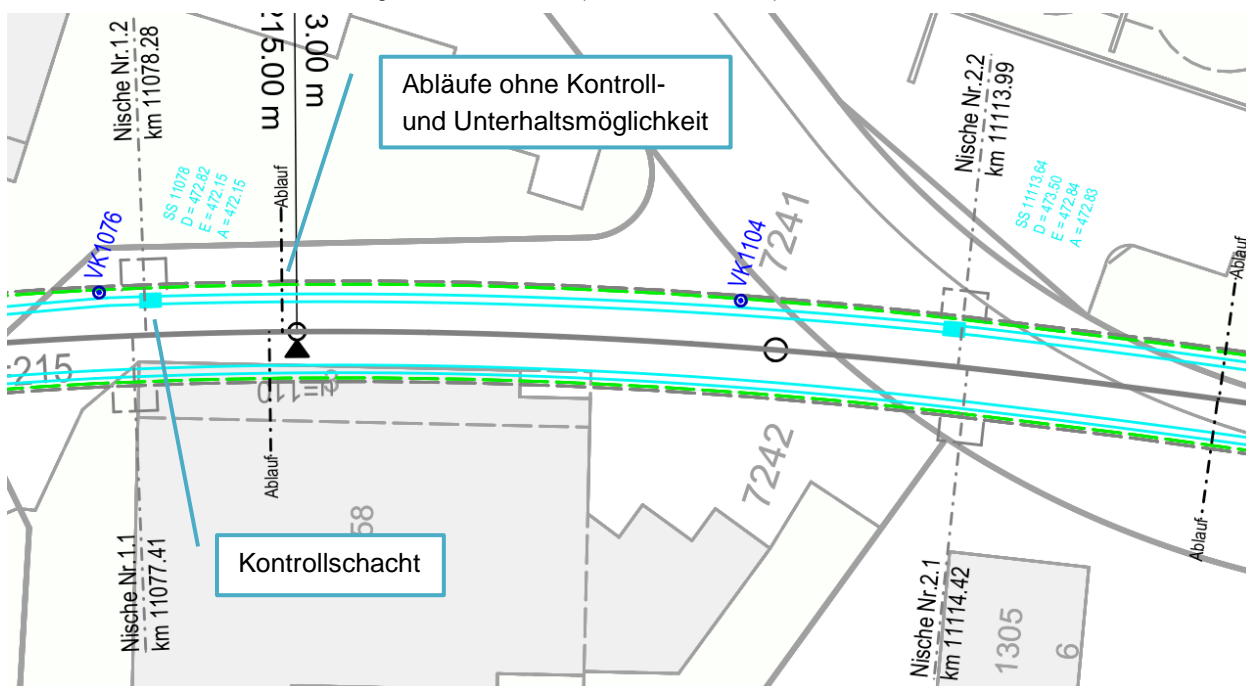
Ausschnitt Bahnplan 47 (Zwischenstand) mit Abläufen Tunnelentwässerung und Kontrollschächten
